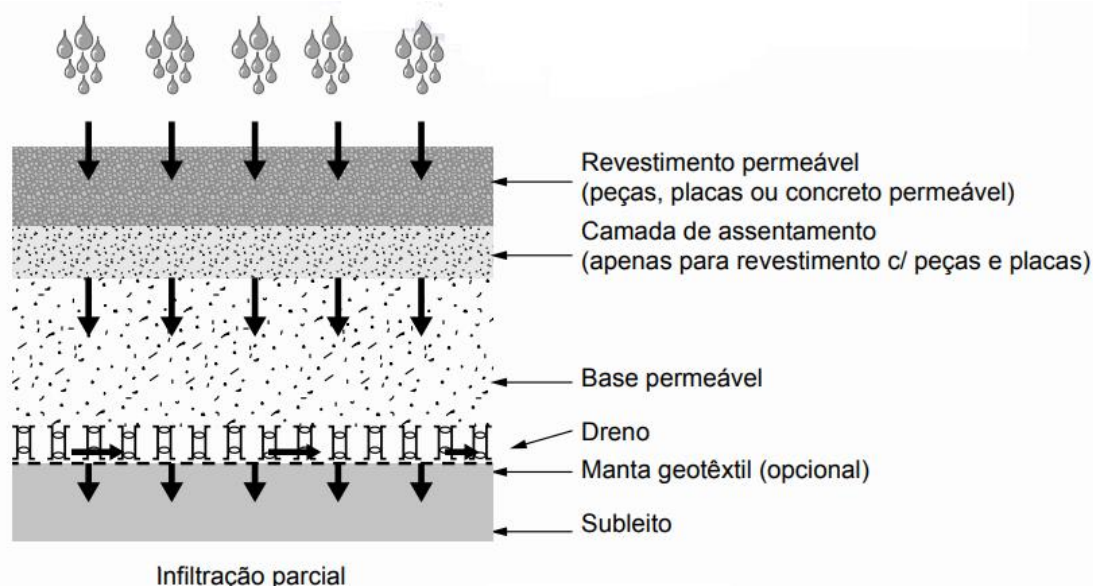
Exemplo de sistema de pavimento permeável com infiltração parcial apresentado na NBR 16416. Fonte: Adaptado de ABNT (2015).
